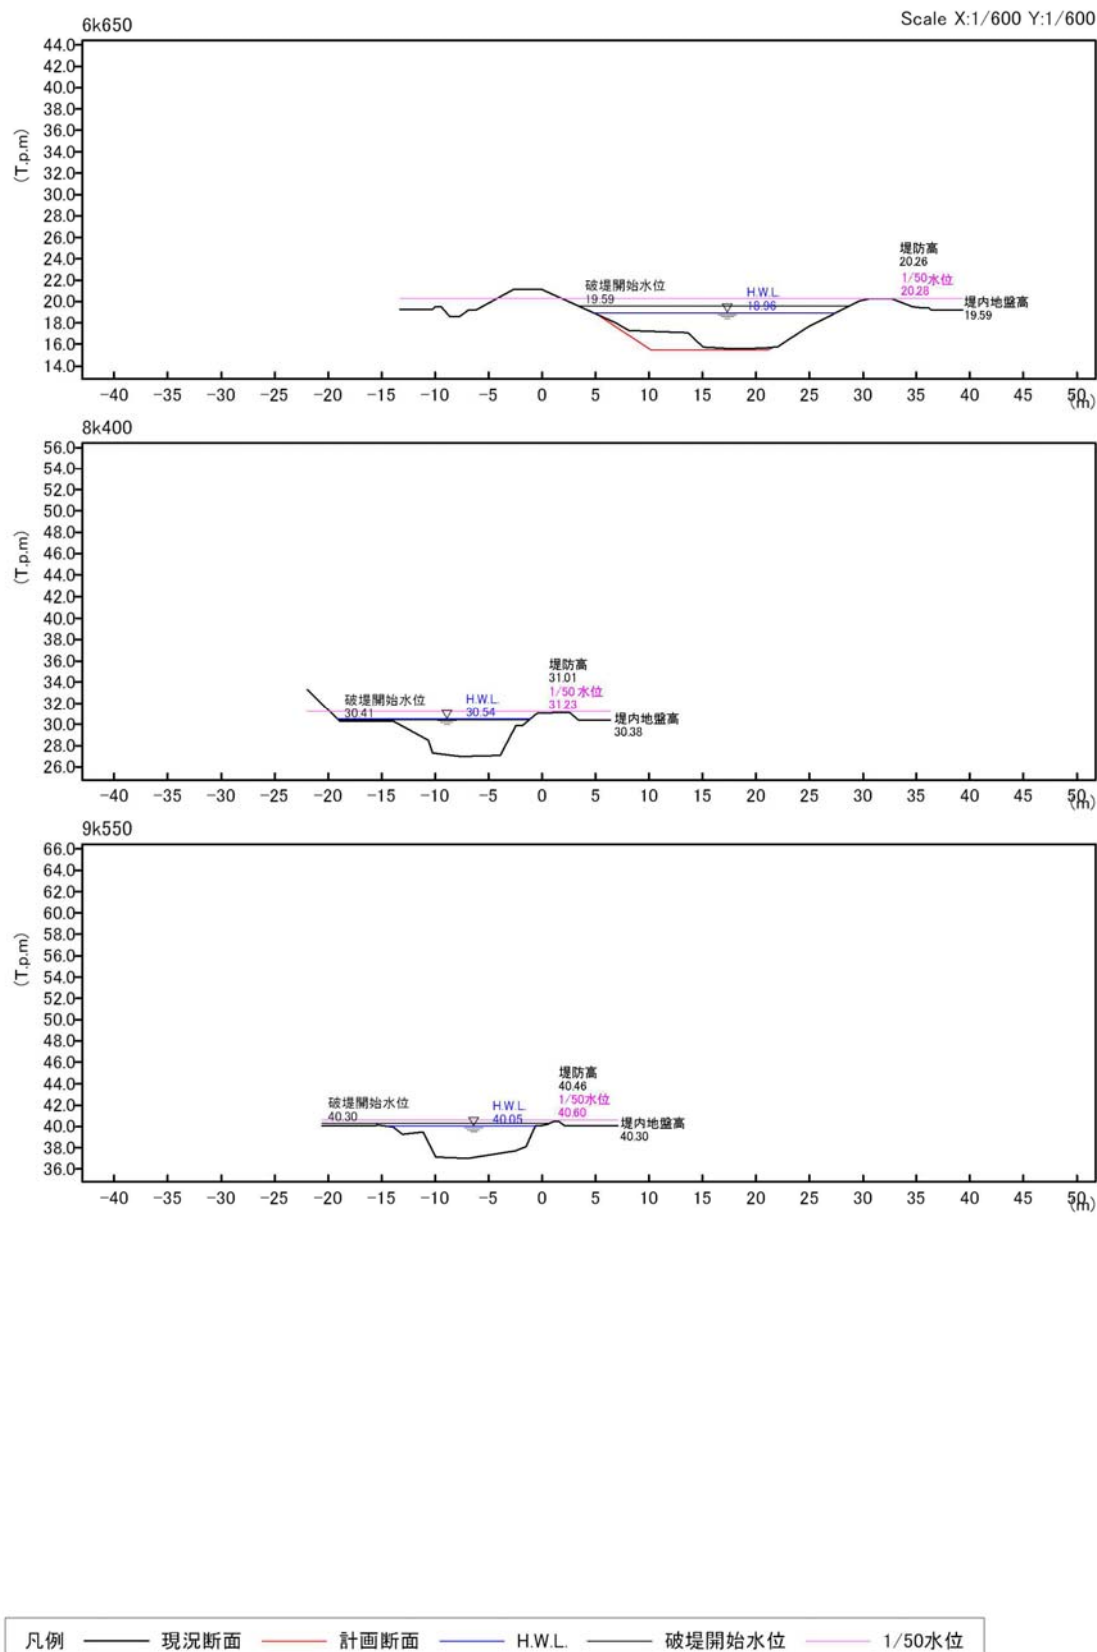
破堤箇所横断面図 都治川右岸 (3/3)
